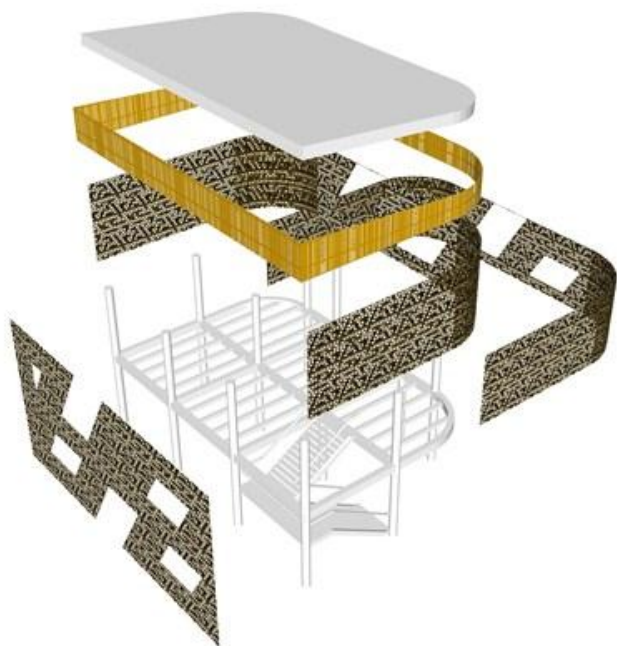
Sistem struktur pada massa penginapan, lobby, dan kantor
